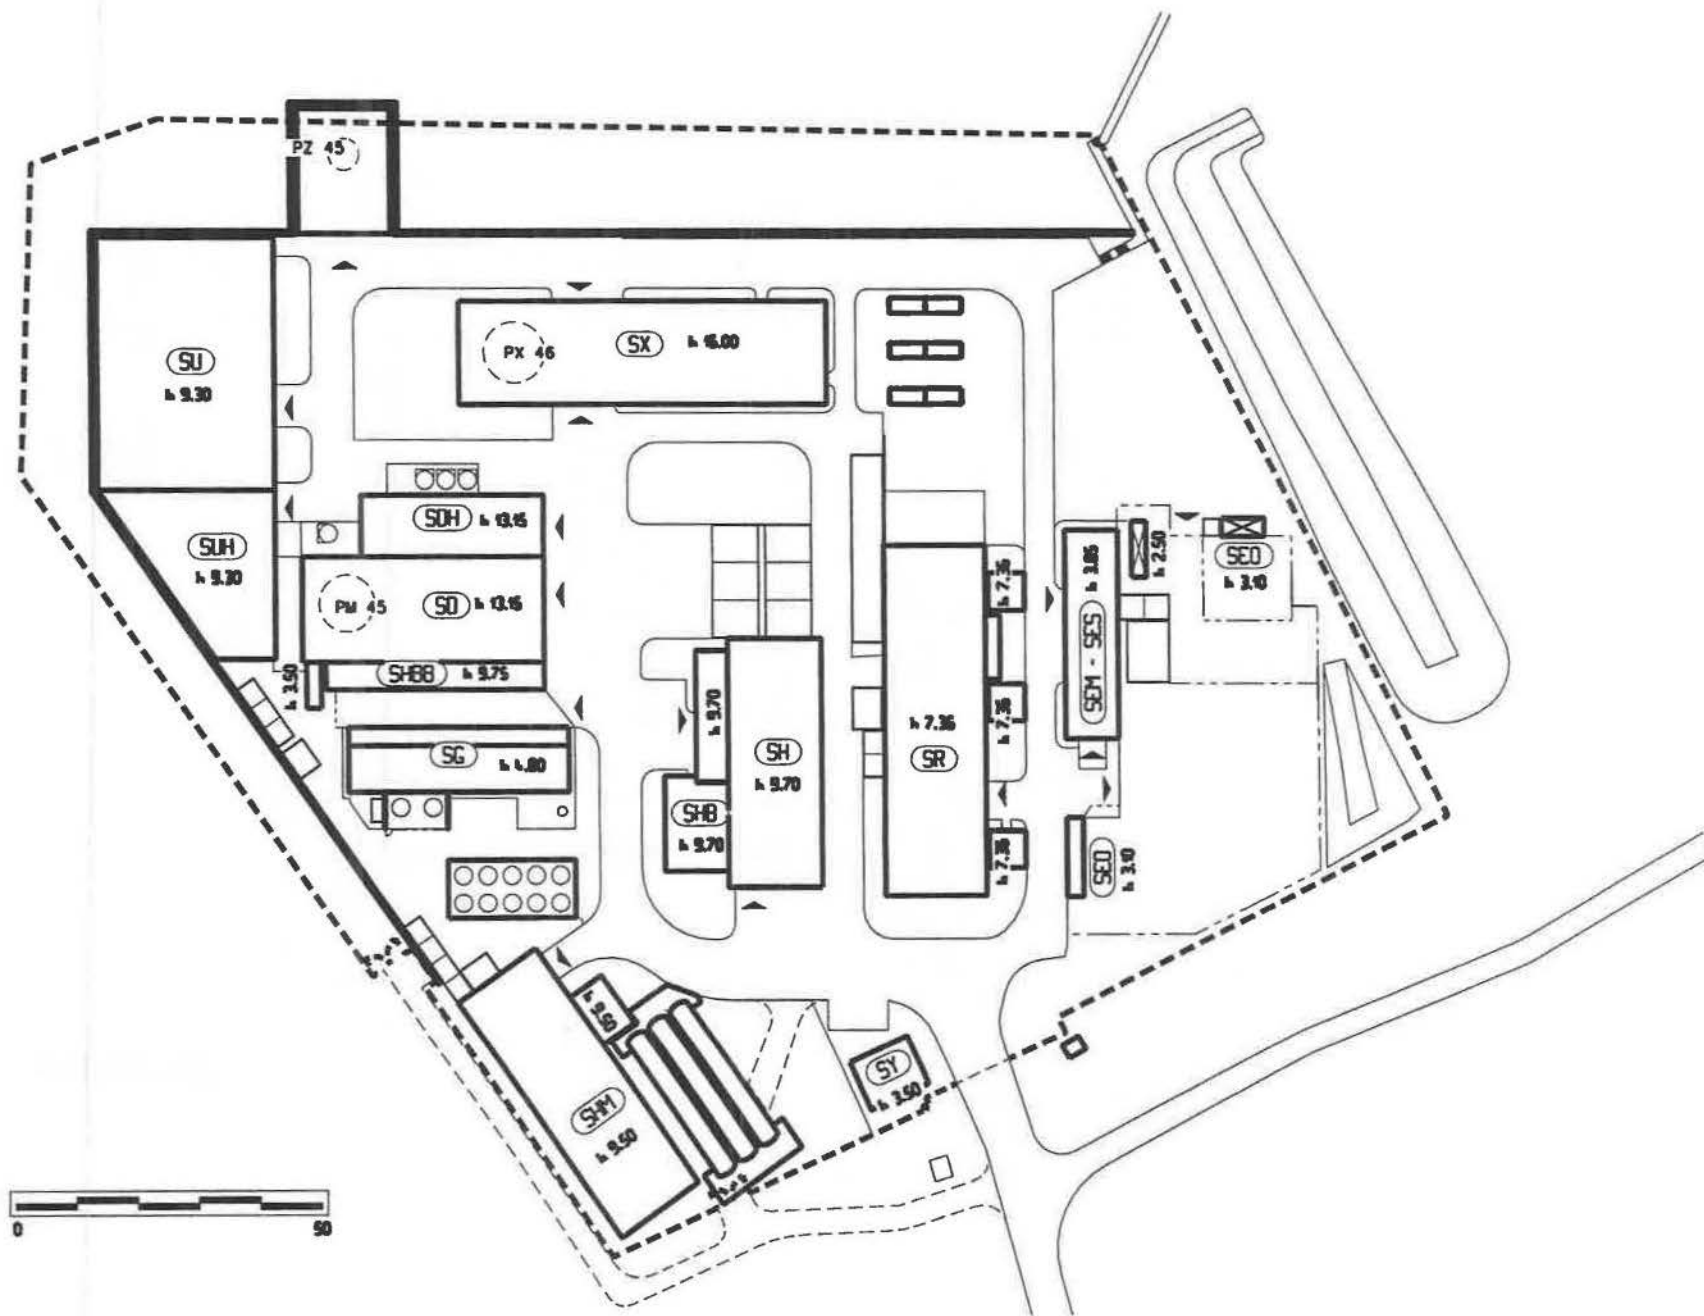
Point 4 : Plan de masse des bâtiments en surface du LHC
